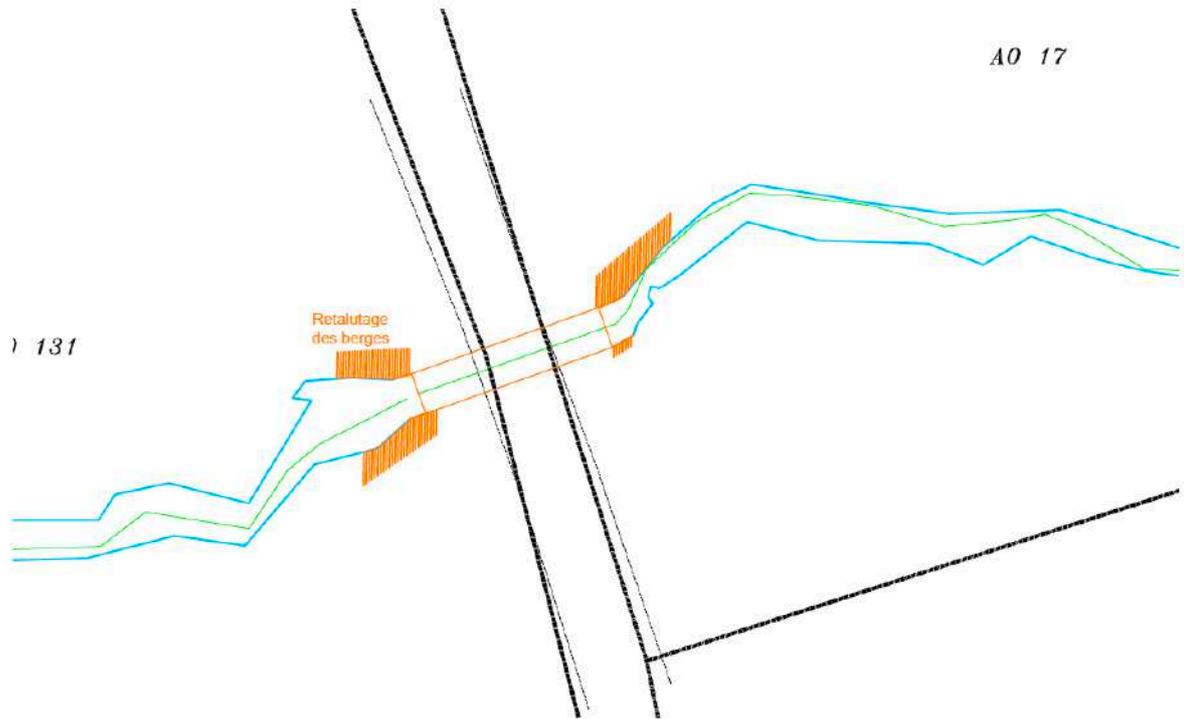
Vue en plan de l'aménagement de l'ouvrage ROE 114756
